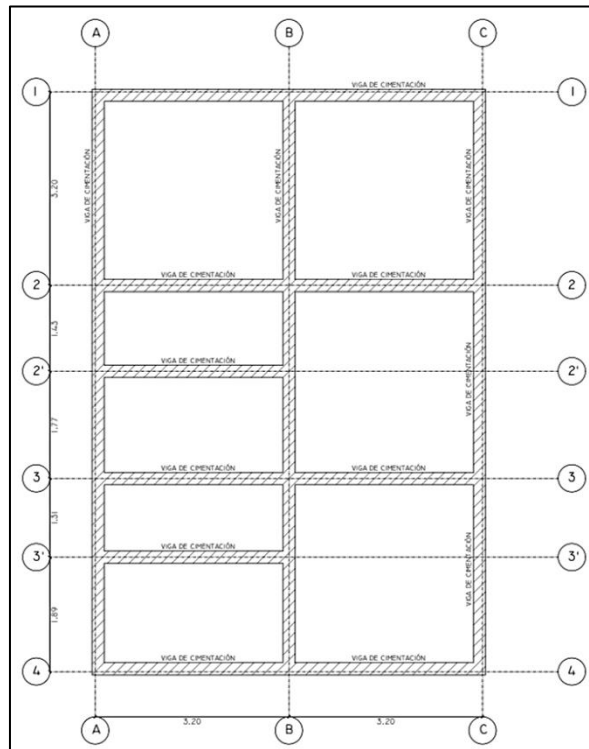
Planta de cimentación vivienda en caña guadua Fuente: (MIDUVI, 2023)
